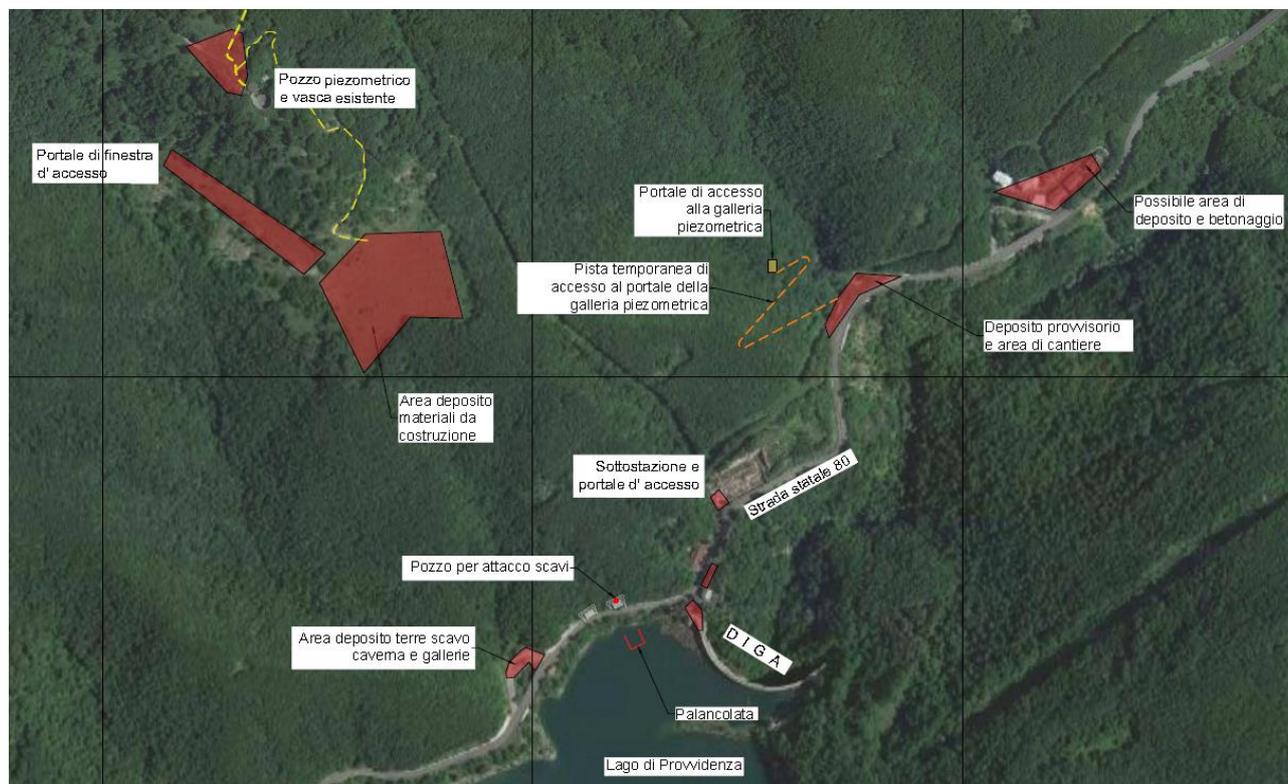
Estratto dal piano di cantierizzazione; in evidenza le aree oggetto di intervento
